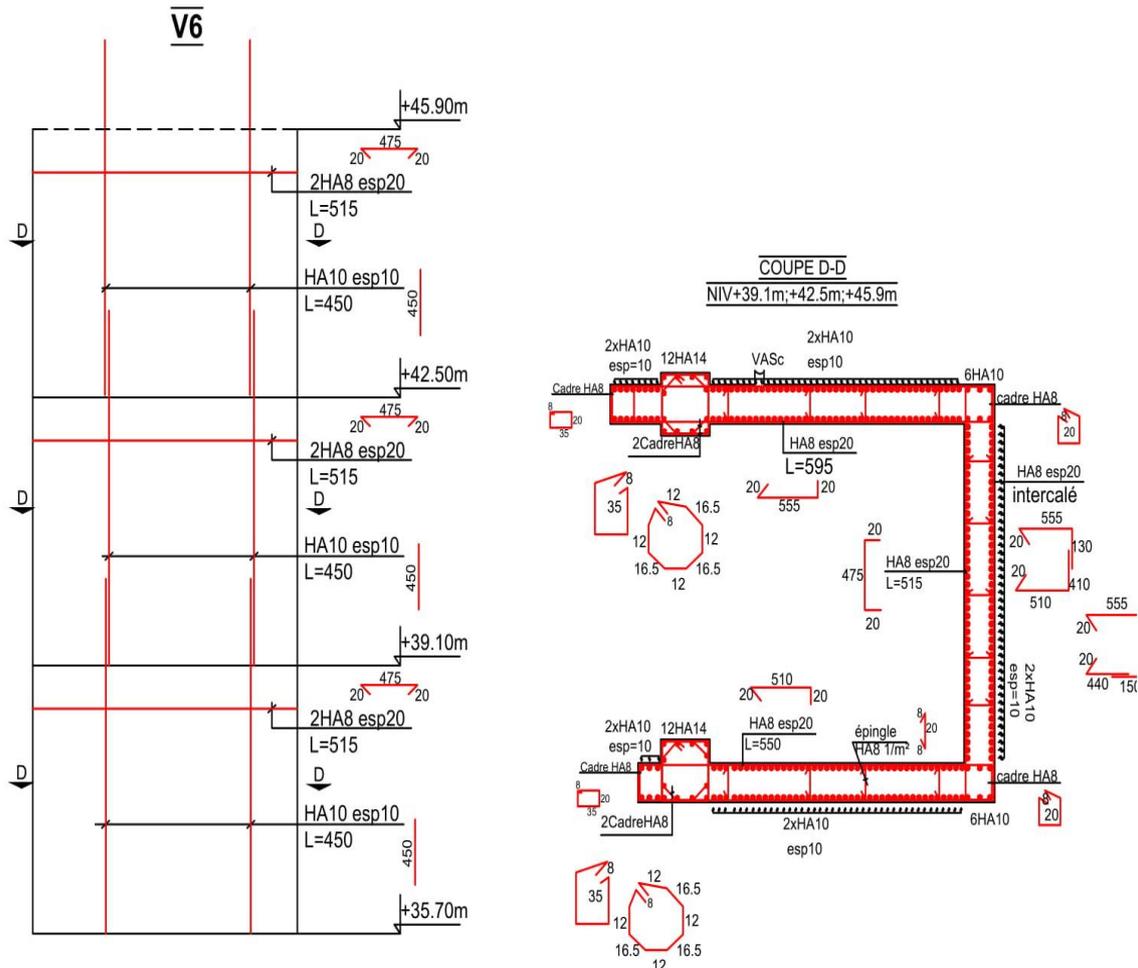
exemple de plan ferrailage d'un noyau central
